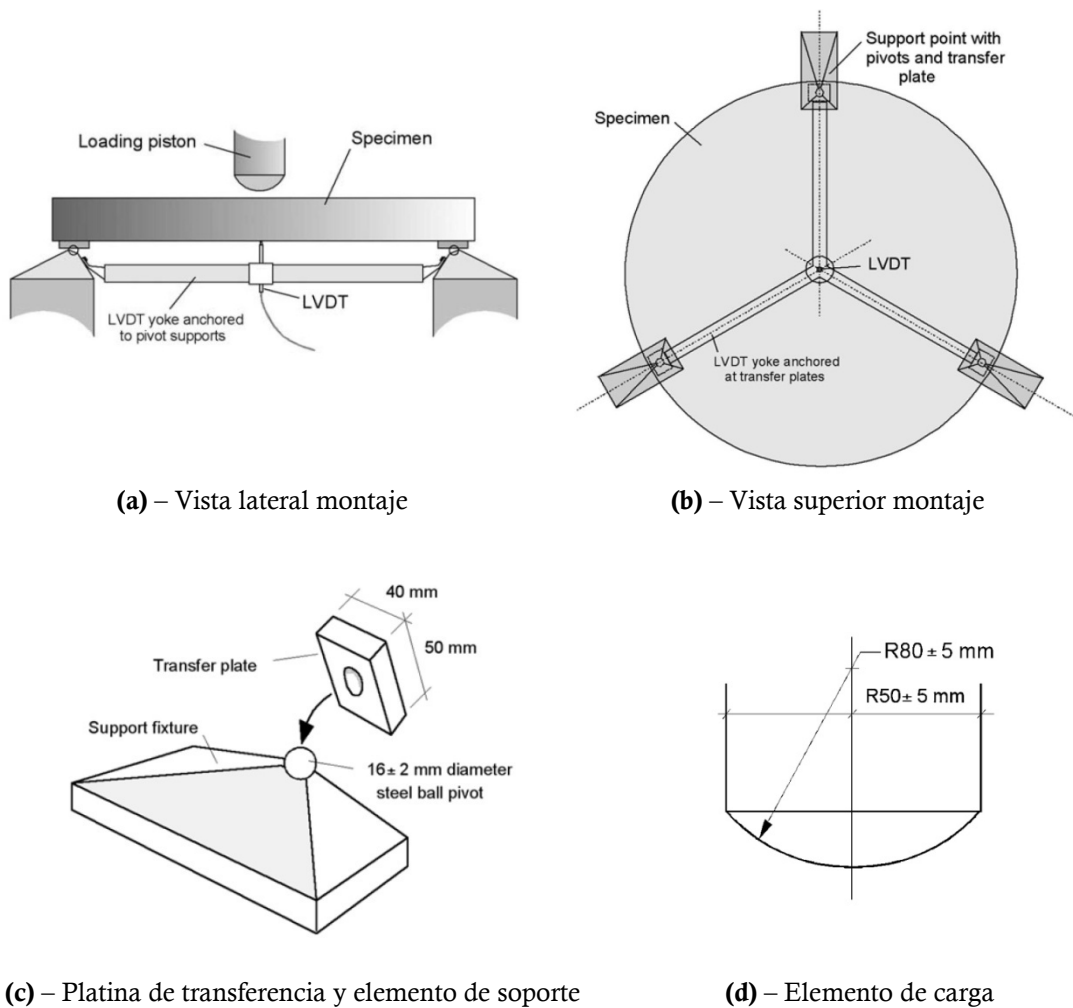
Esquema montaje placa circular (ASTM C 1550-10)
